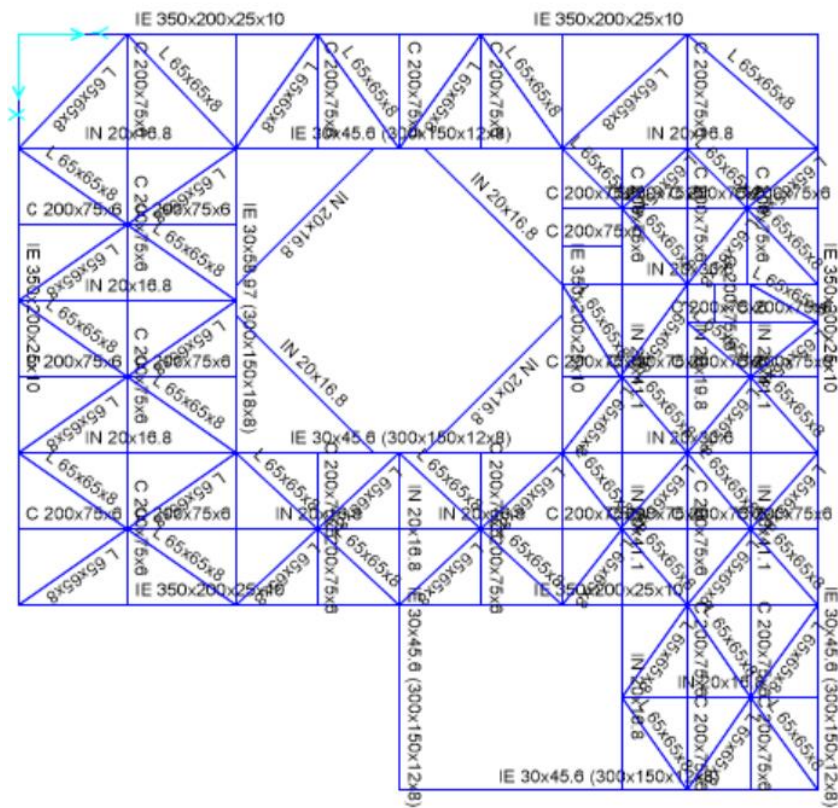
Vista en planta 5.8 [m] sobre nivel de terreno.
